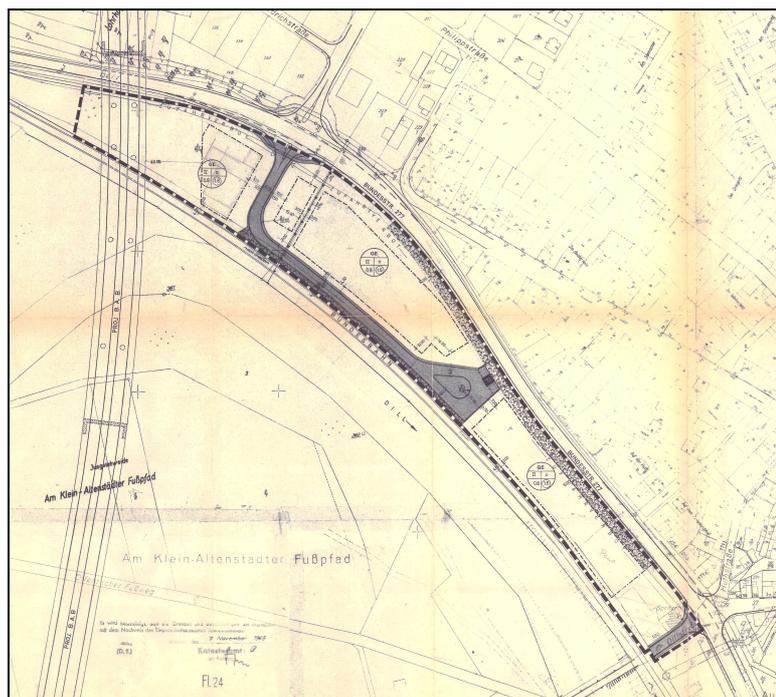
Bebauungsplan „Zwischen der Bundesbahn, der projektierten BAB Reiskirchen - Montabaur und der Bundesstraße 277“
